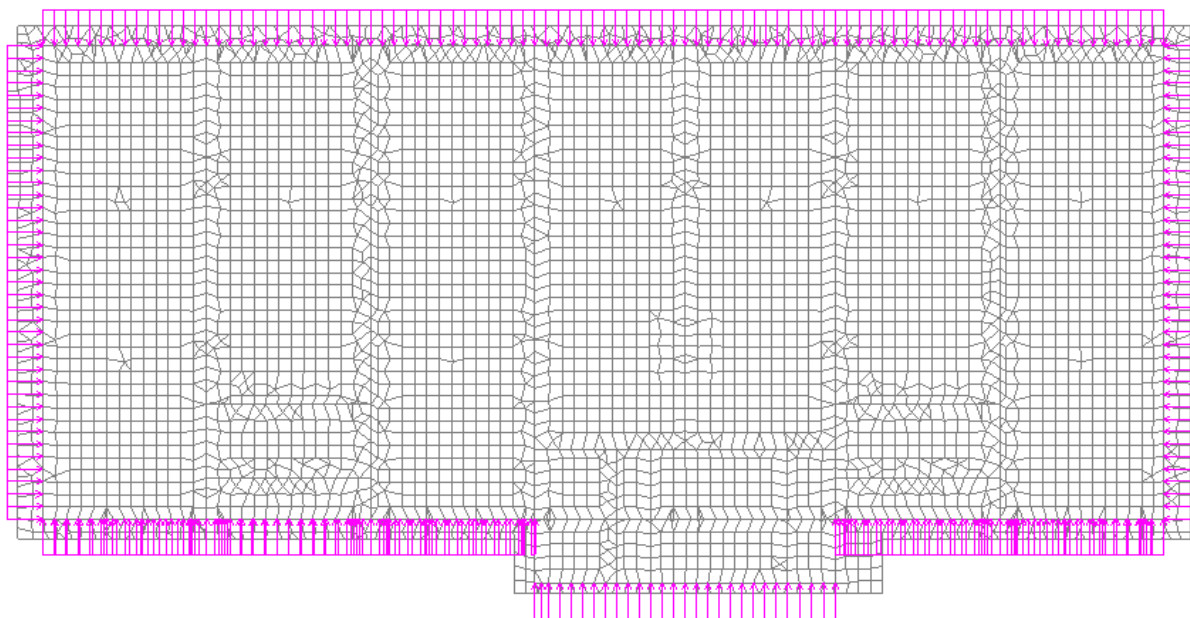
Схема приложения нагрузки от грунта на внешние стены
